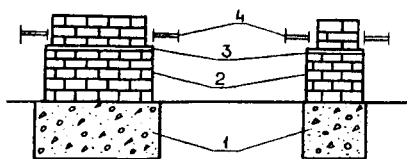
Кладка фундамента; 1 — бутовая кладка; 2 — кирпичная кладка; 3 — изоляционный слой; 4 — уровень пола
